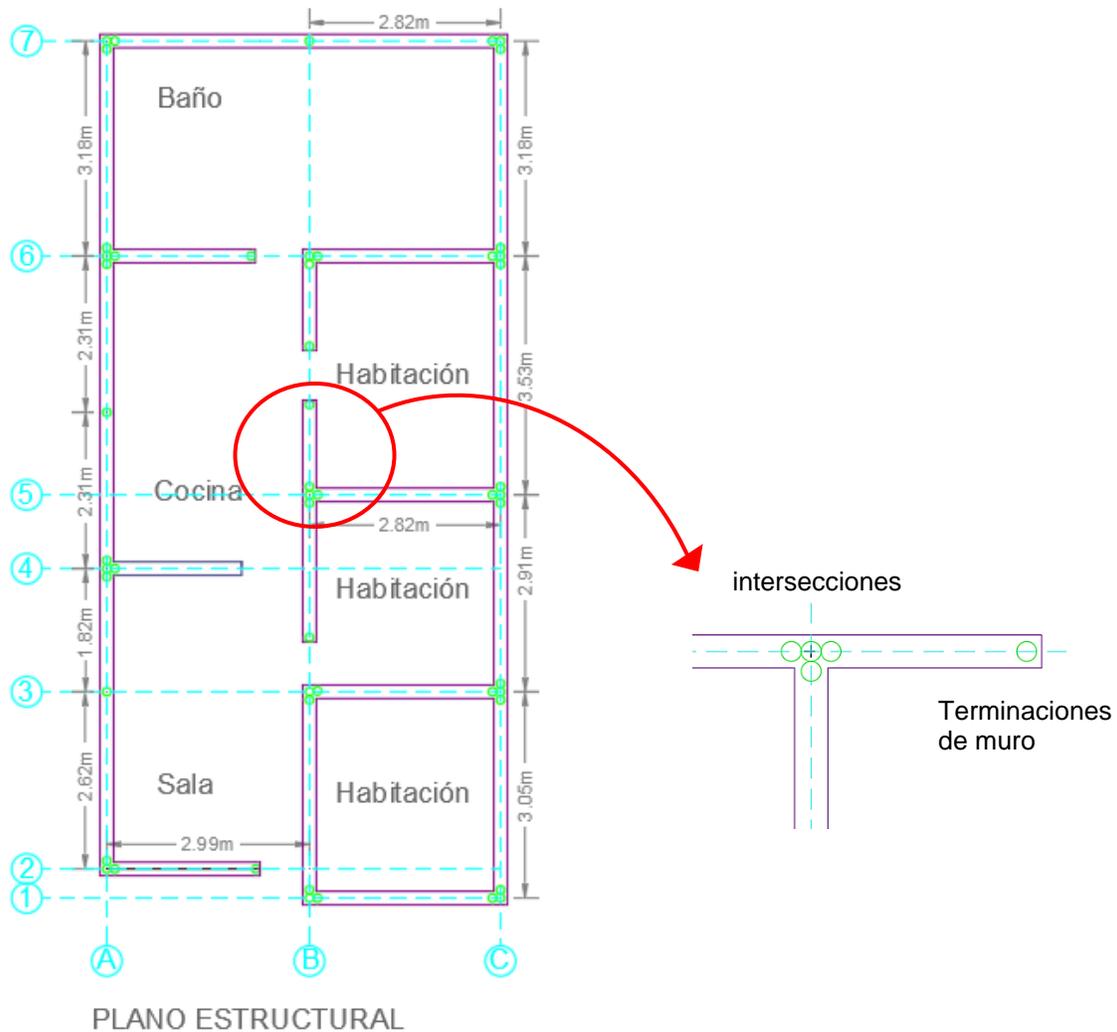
Detalle de distribución de guaduas por columnas en vivienda de beneficiaria Magali Rozo.
